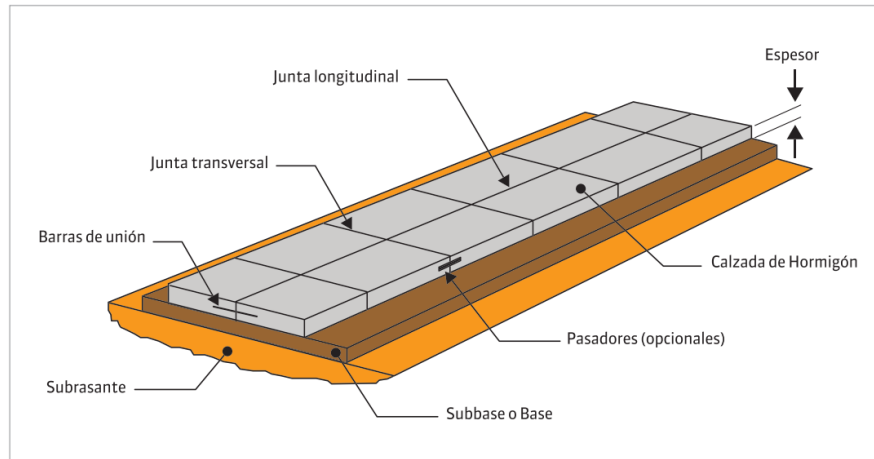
Estructura tipo de un pavimento rígido. Fuente: MDCPH
